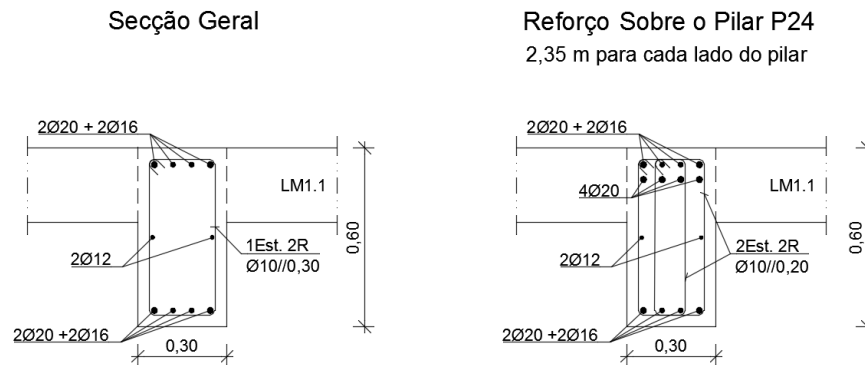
Pormenor da secção transversal da Viga 2.1.
